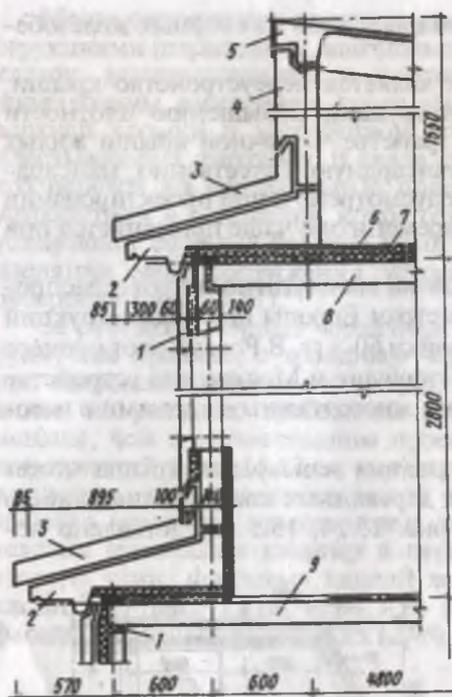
Детали устройства мансарды при размещении с отступом от плоскости фасада: 1 — утепленная панель наружной стены; 2 — карнизная плита; 3 — облицовочная плита; 4 — фризная панель чердака; 5 — кровельная панель; 6 — утеплитель; 7 — пароизоляция; 8 — панель чердачного перекрытия; 9 — панель междуэтажного перекрытия
